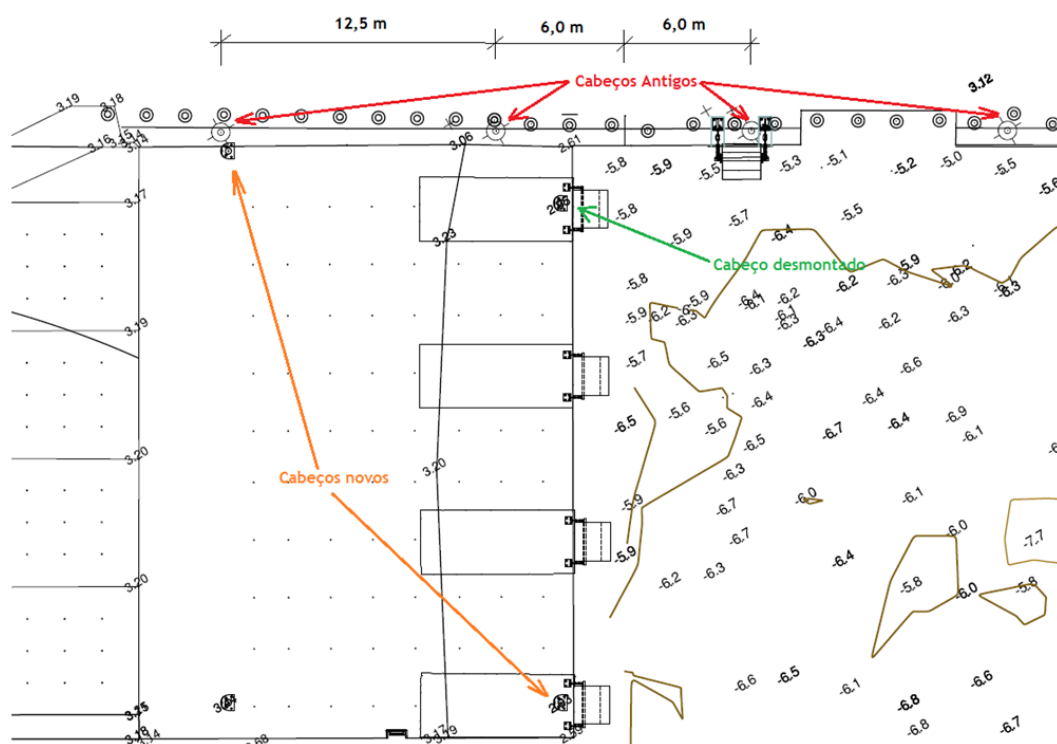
Extrato da Planta de Implantação da rampa Ro-Ro
